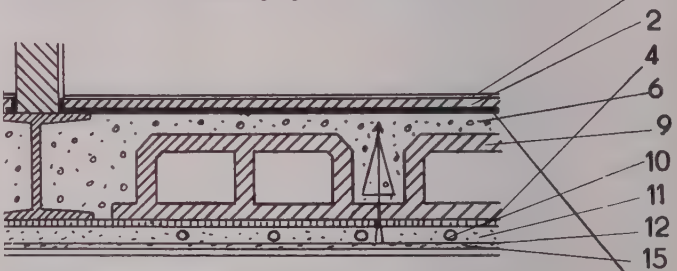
Stahlträgerdecke mit Hohlkörpern
